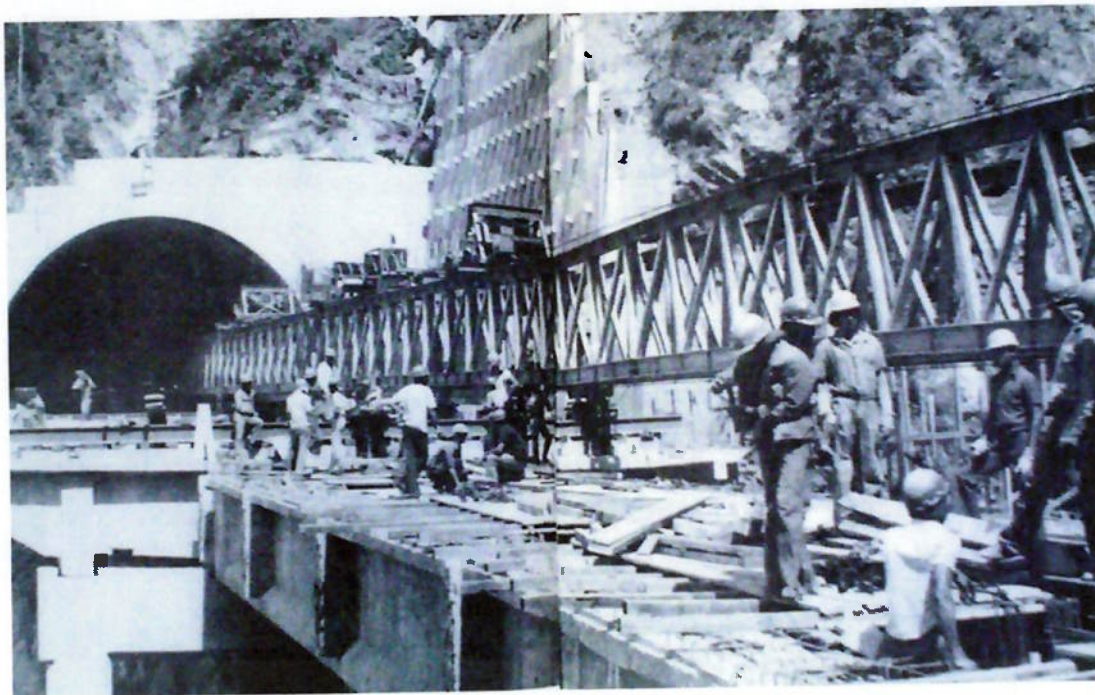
Viga protendida sendo colocado por meio de treliça metálica.
